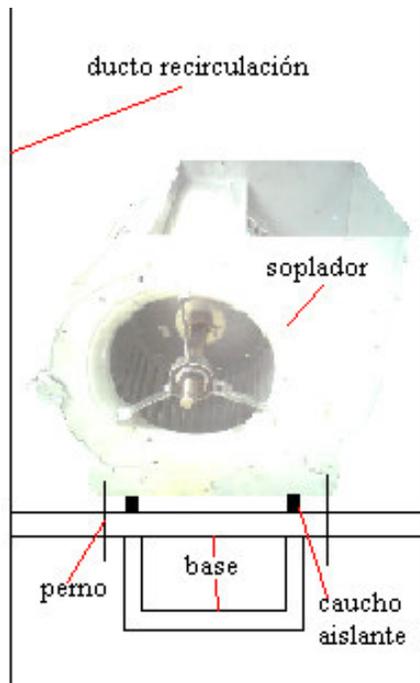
Esquema montaje del ventilador soplador en ducto
